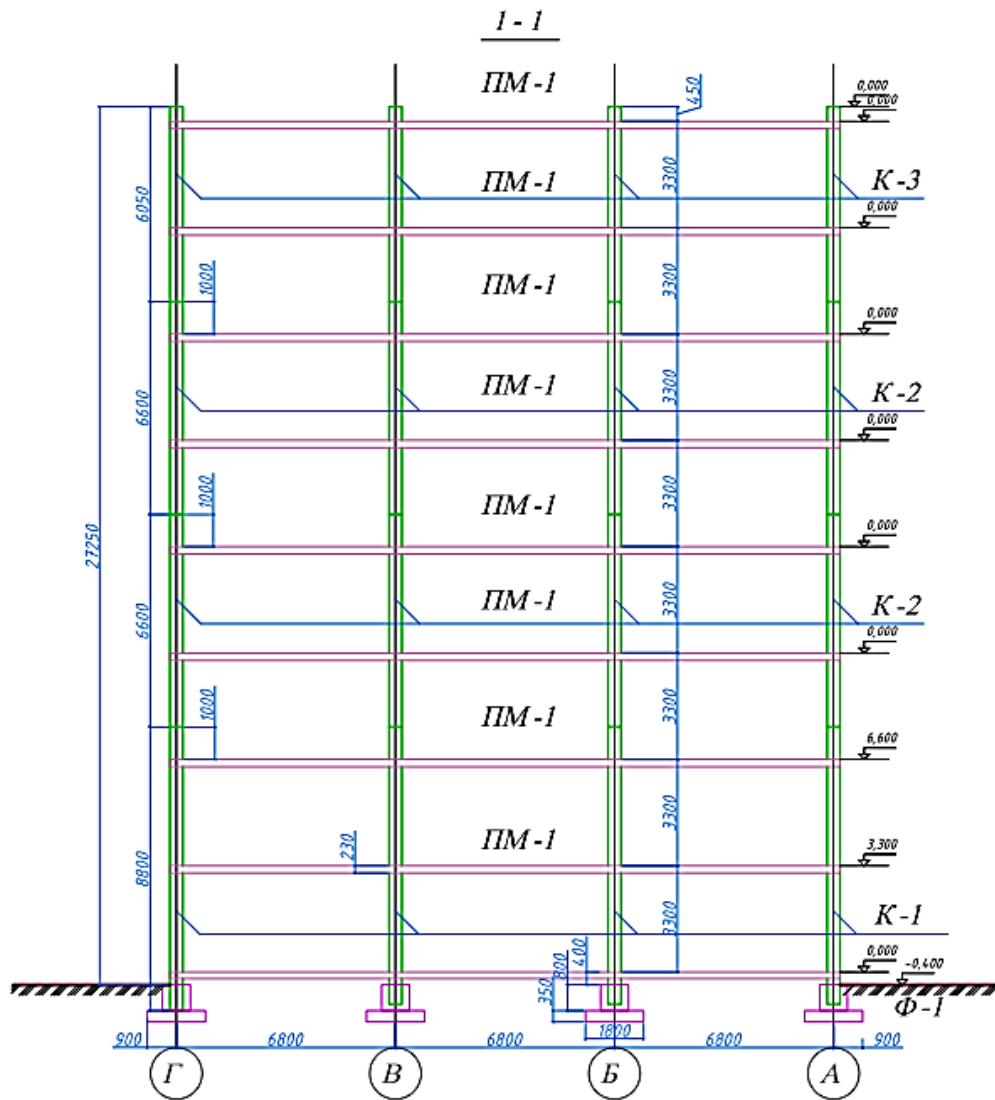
Маркувальна схема конструкцій каркасу будівлі (розріз 1 – 1):
